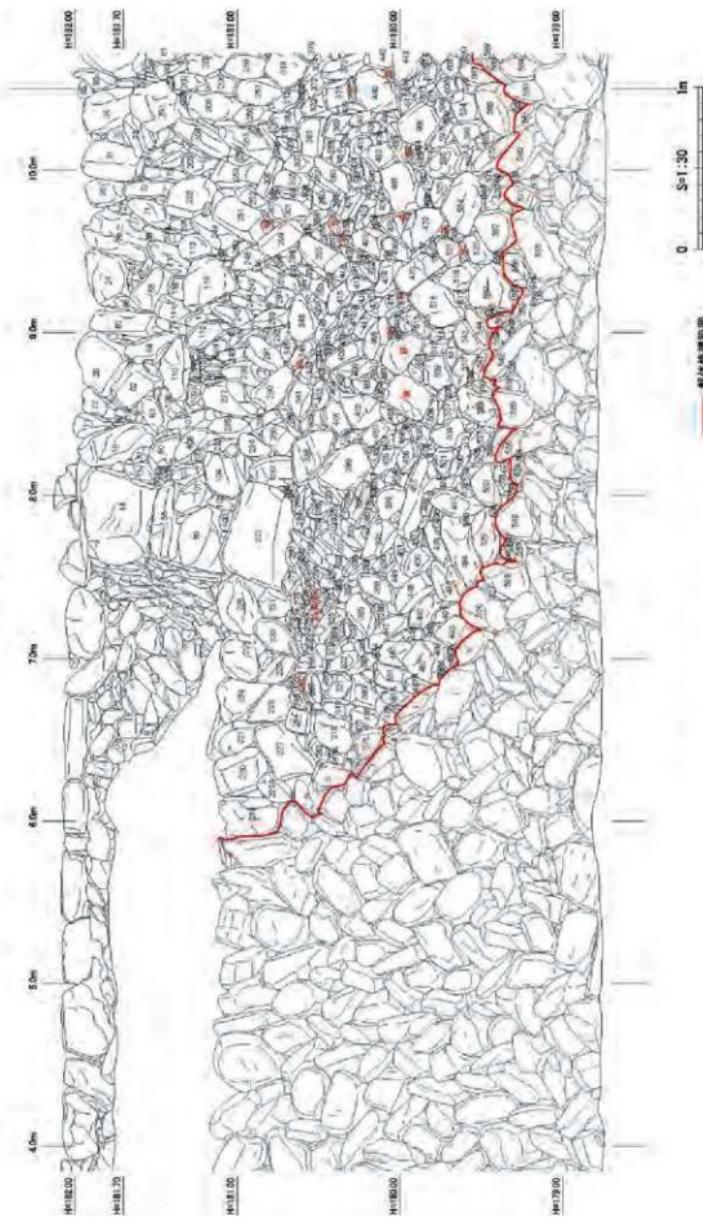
石垣 A 修復後石材番号配置図 (西側)
